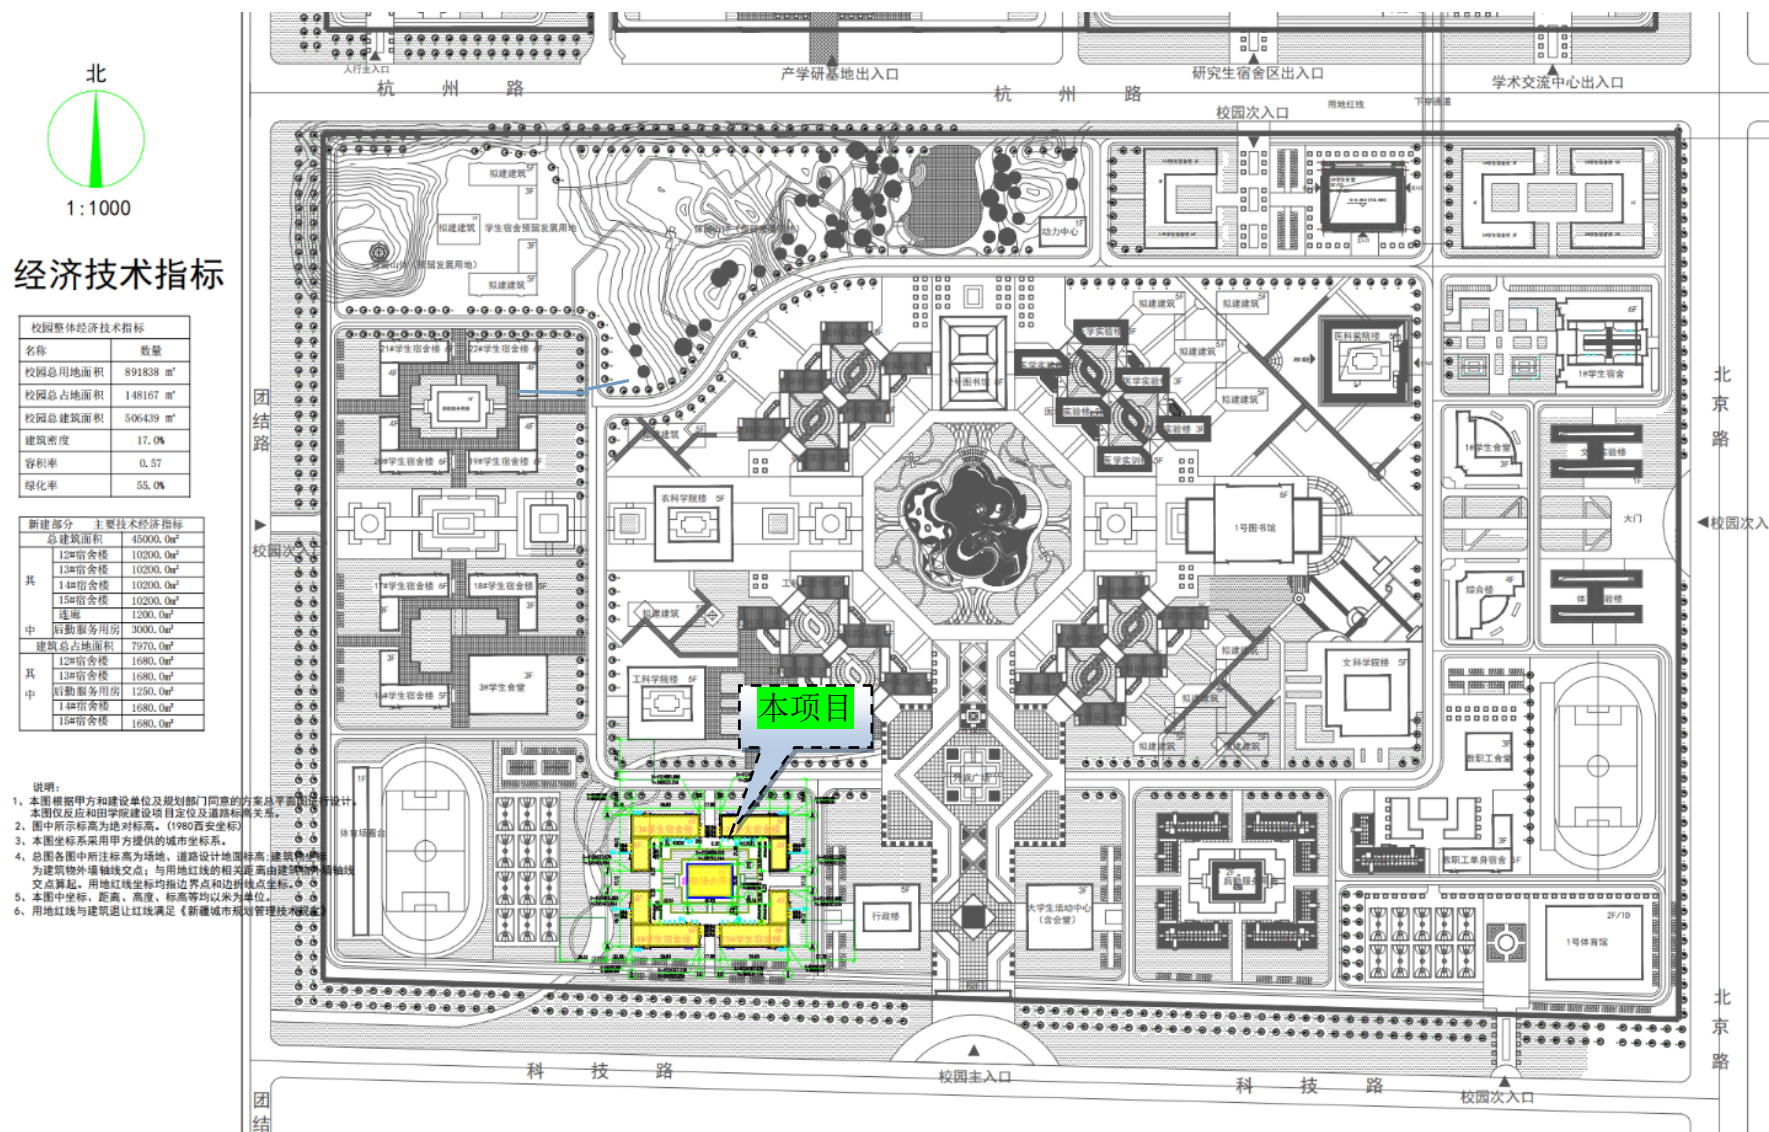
项目平面布置图 (红线区域为本次建设范围)
